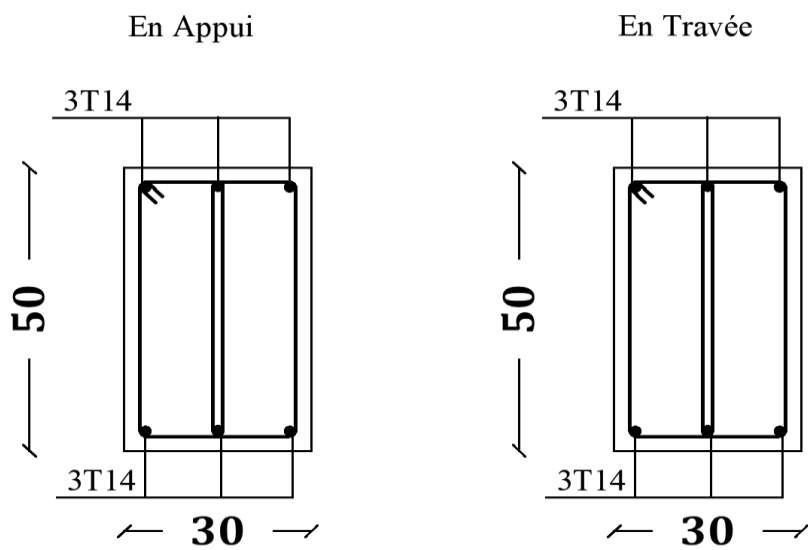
ferrailage de poutre étages courants (30*50cm²).
